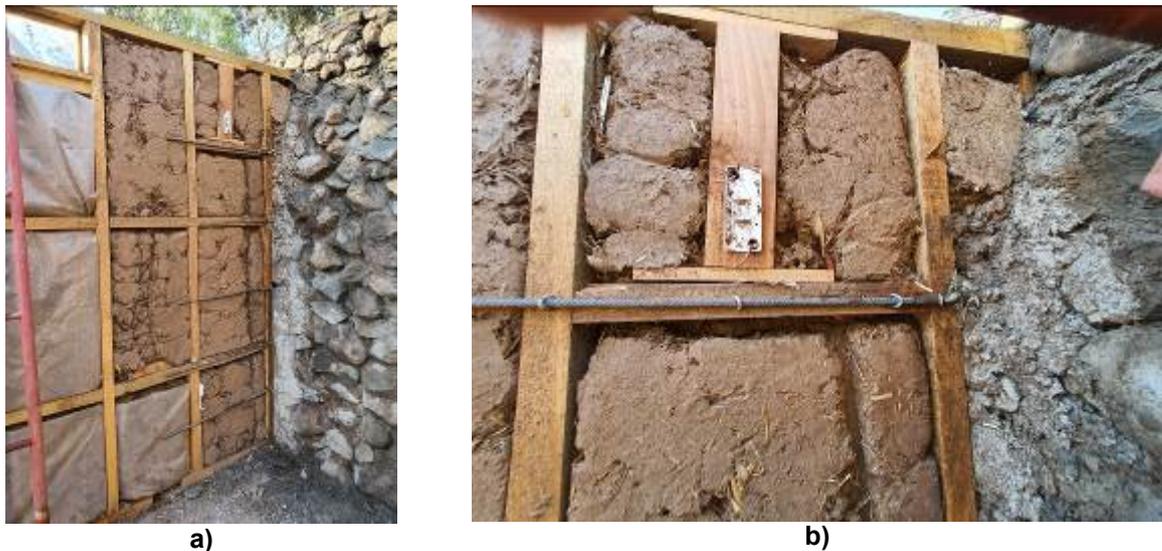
a) unión del muro de quincha con pirca; b) detalle de barras metálicas penetrando la pirca
